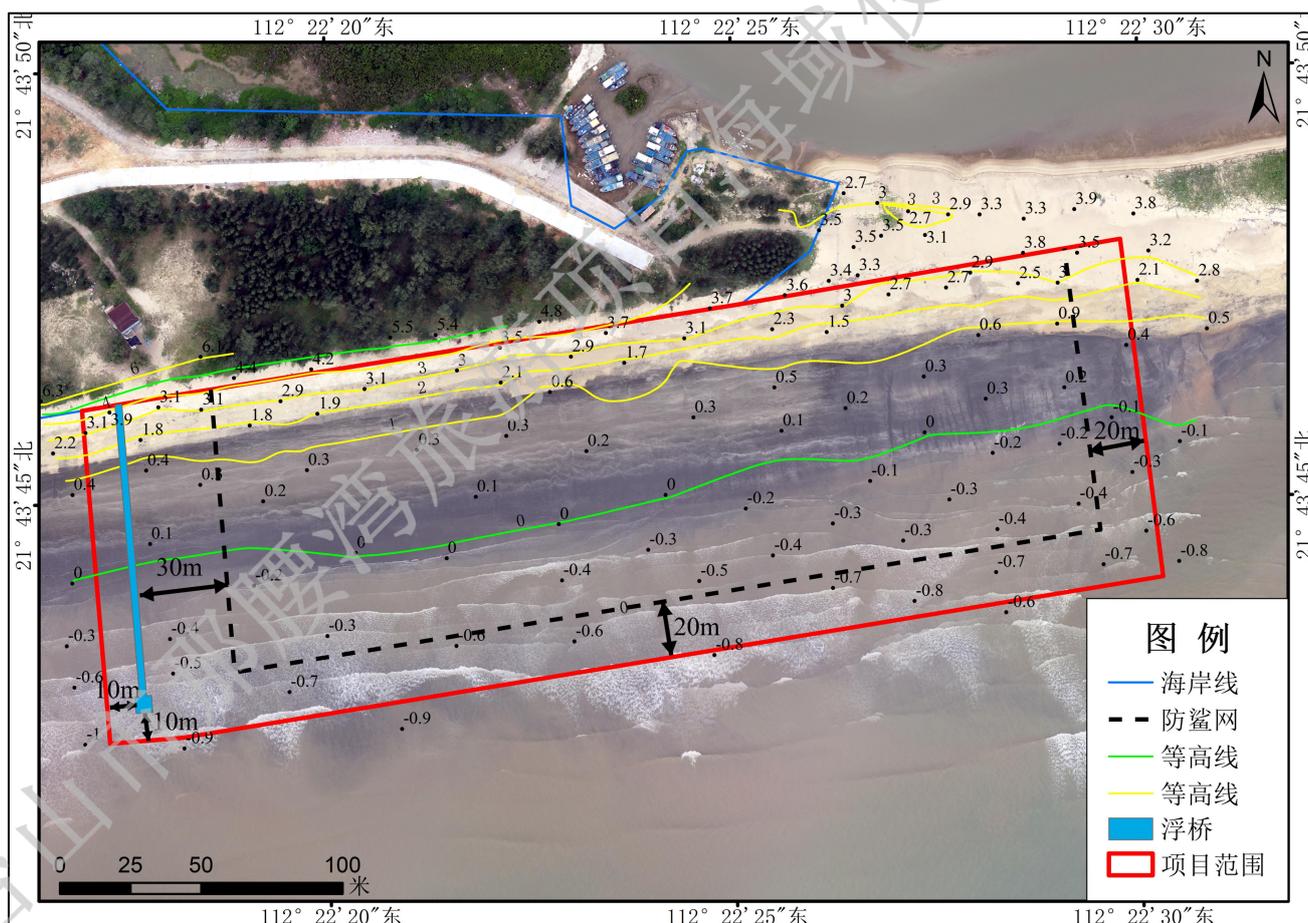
平面布置图（高程基准：1985国家高程基准）
